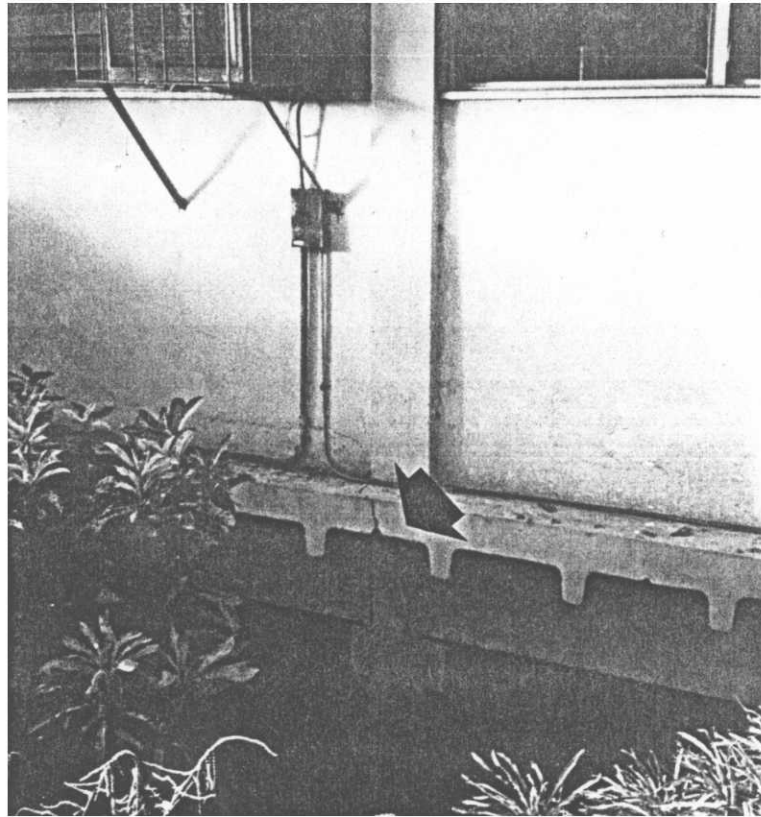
Separación entre elementos portantes a nivel de vigas y losa.
